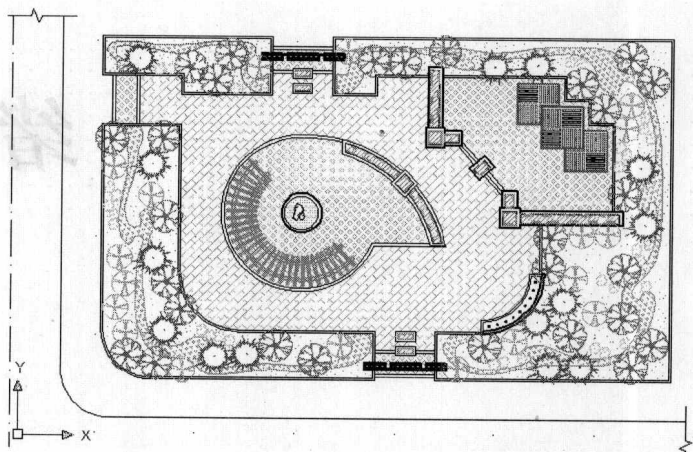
用 AutoCAD 绘制的园林设计平面图
